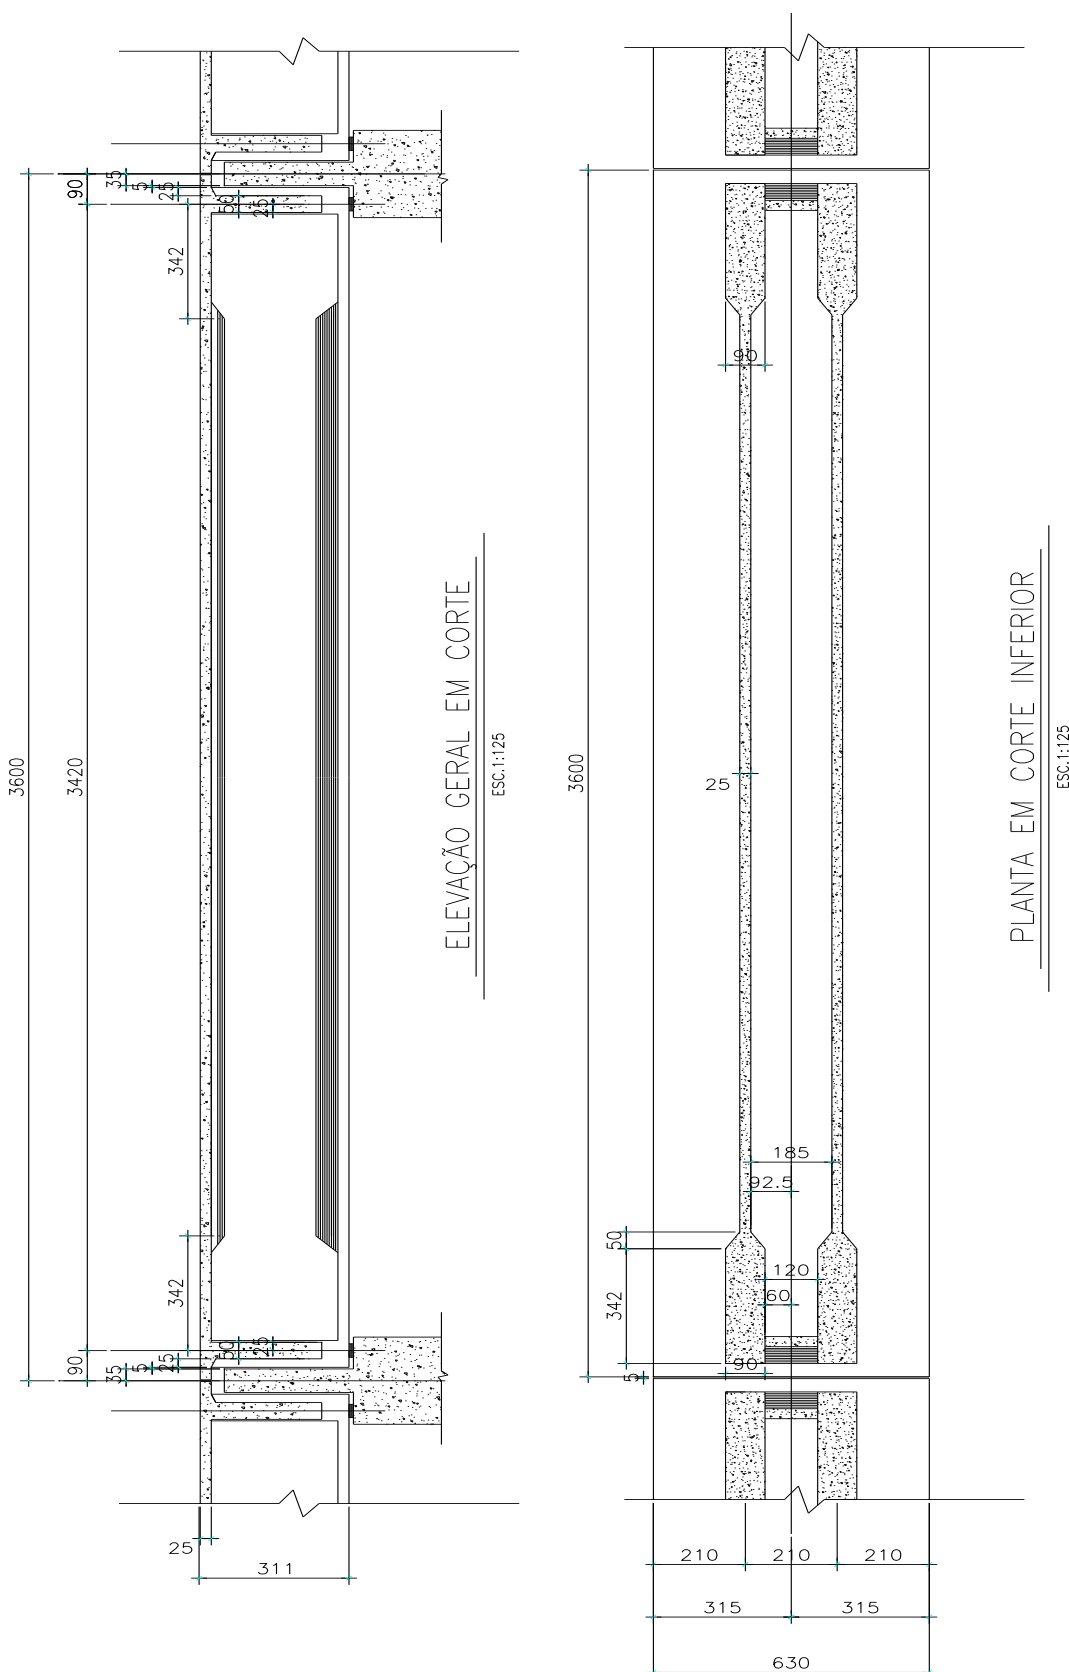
relação 1/11 – corte longitudinal e planta do tabuleiro
